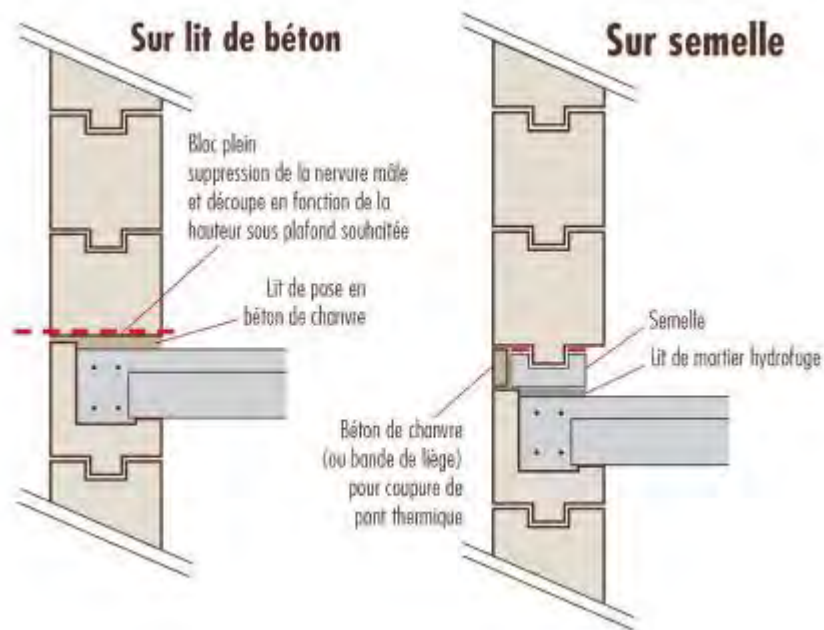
principes de redémarrage de mur sur plancher de haut de rez-de-chaussée
